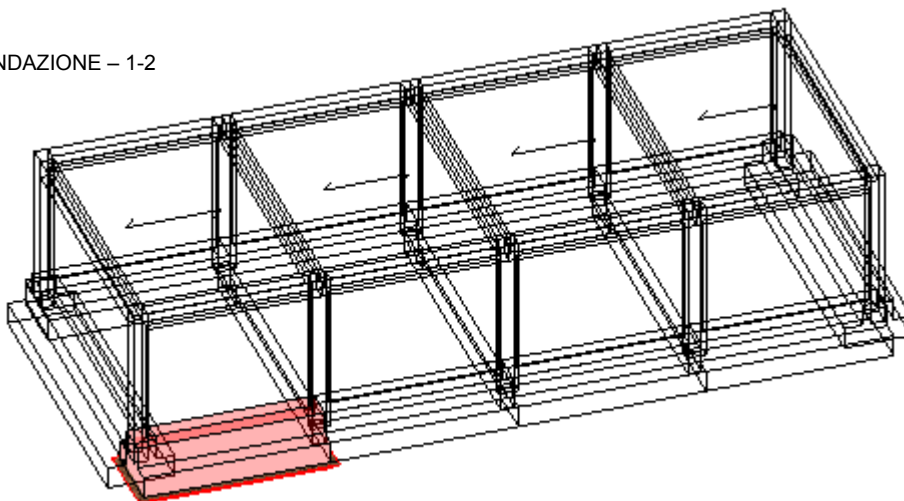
Modello di analisi - Travi di fondazione 1-6/1-2
